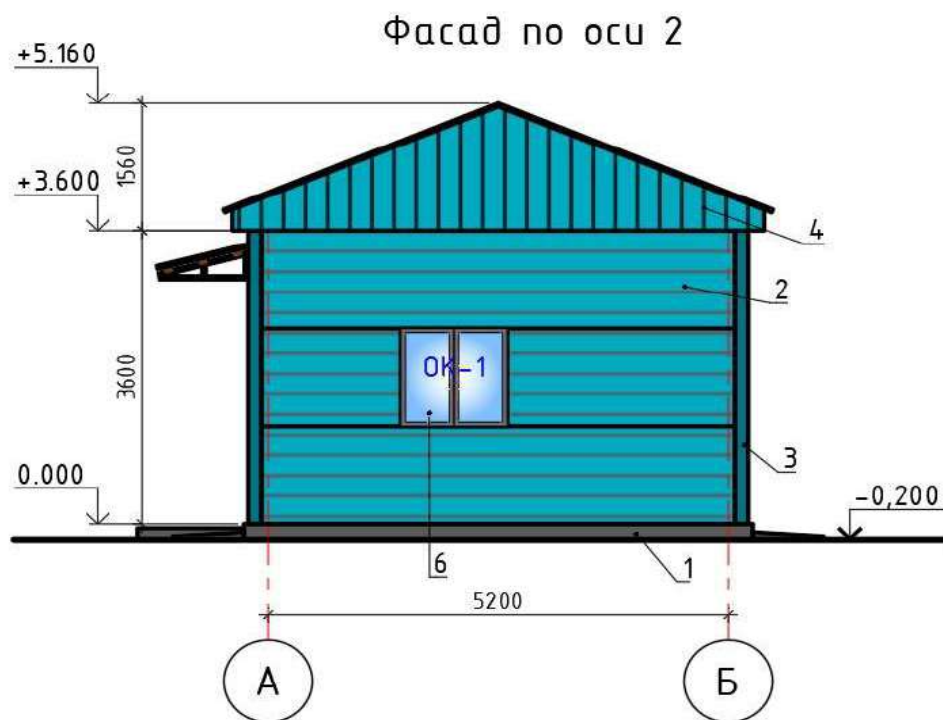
Фасады здания узла рудоподготовки и сгущения
